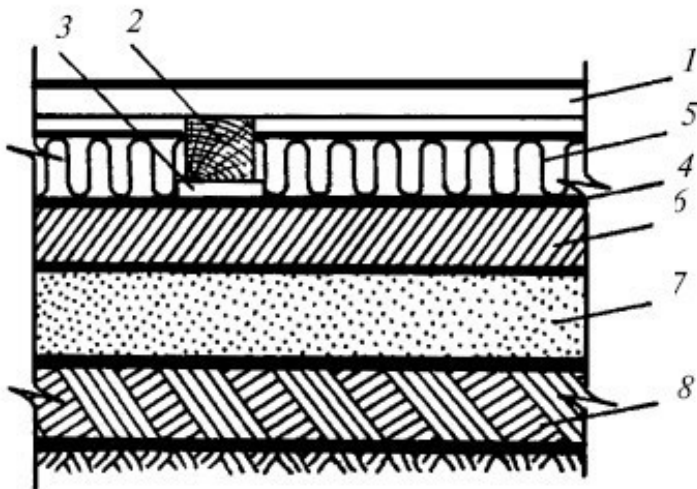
Утепление пола, уложенного по грунту: 1 – пол; 2 – балка; 3 – прокладка-антисептик; 4 – гидроизоляция; 5 – теплоизоляция; 6 – цементно-песчаная стяжка (не менее 50 мм); 7 – песчаная подсыпка; 8 – грунт
